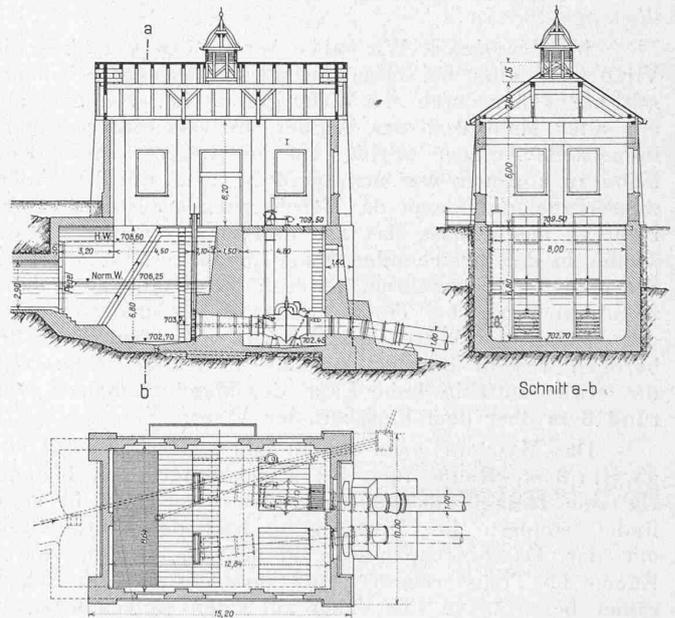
Das Wasserschloss; Grundriss und Schnitte 1: 400.
